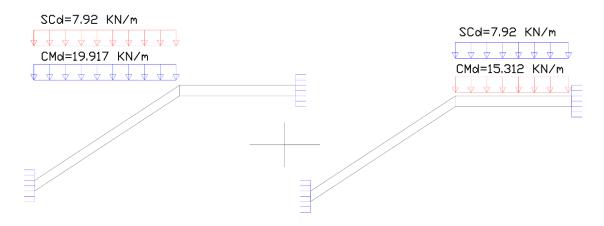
Consideración de la escalera para el cálculo de la armadura negativa.
